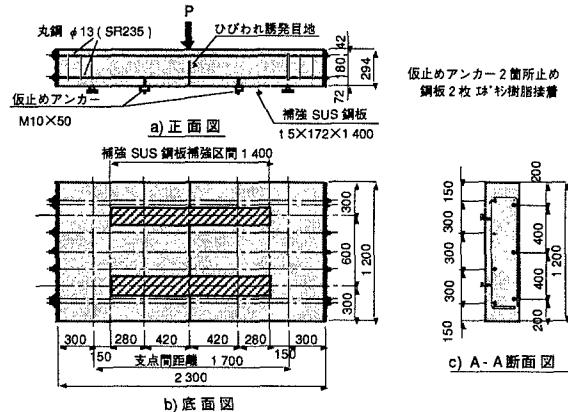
試験体の形状寸法・配筋状況 (S22 試験体)
